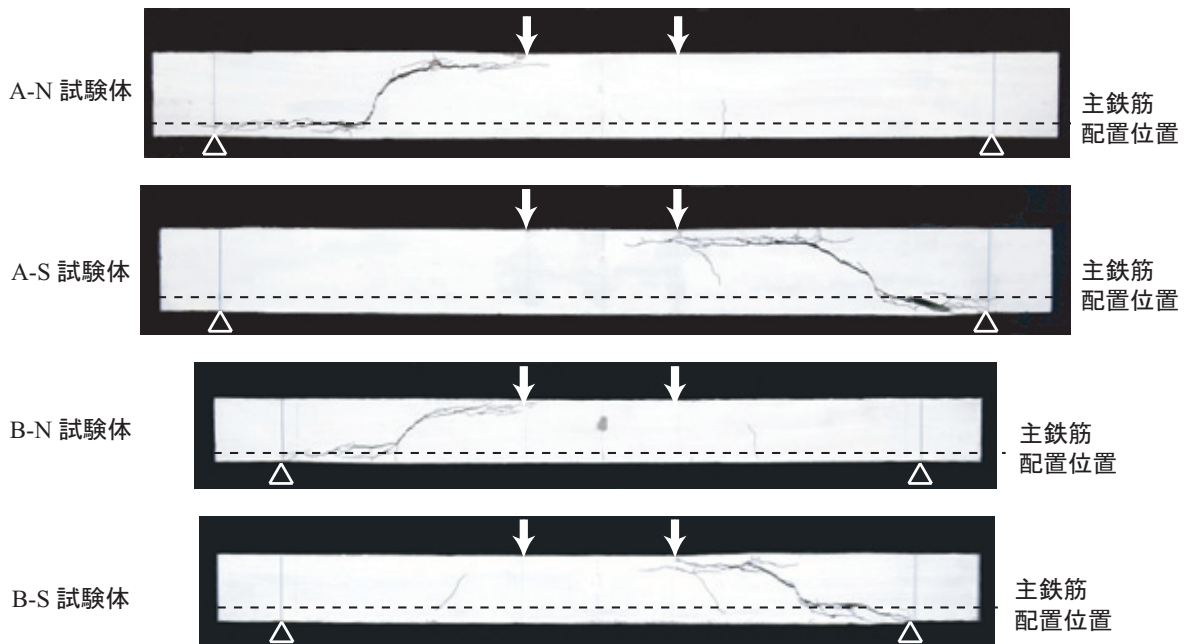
実験終了後における RC 梁側面のひび割れ状況
